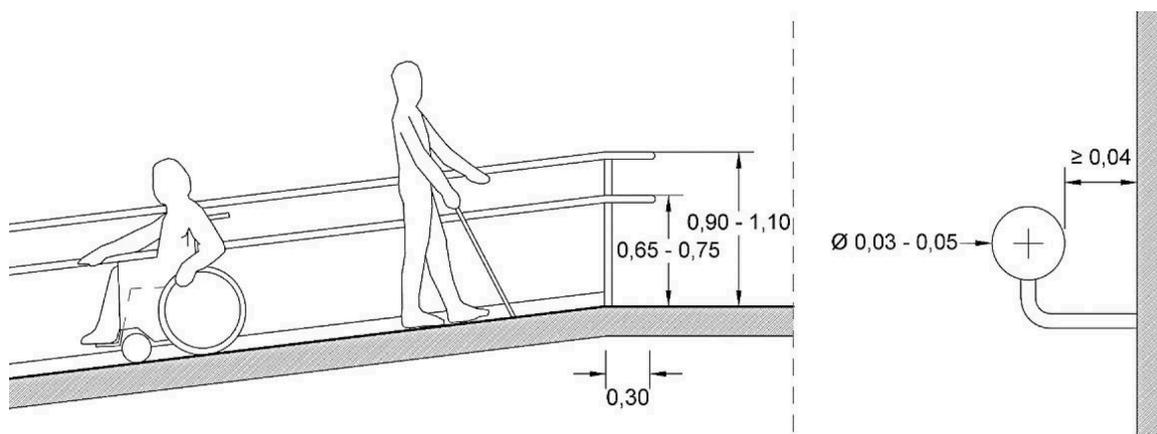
19. Características principales a tener en cuenta en el diseño y la disposición de los pasamanos (cotas en metros)
